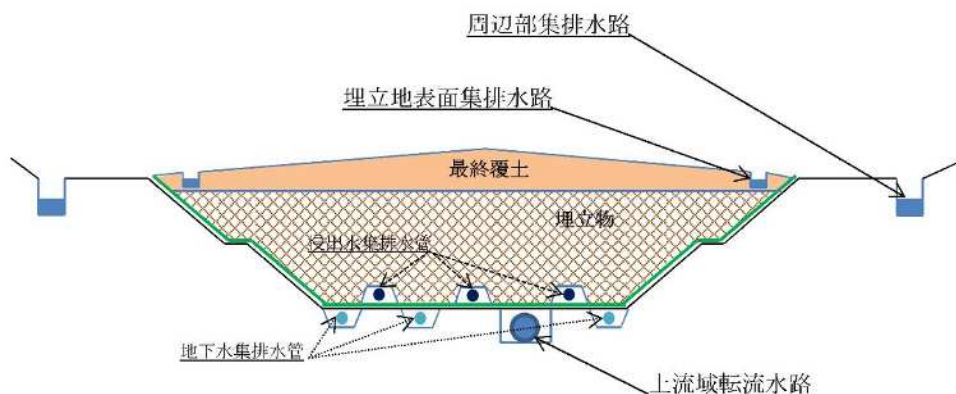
雨水集排水路配置概略断面図例（埋立完了後）
